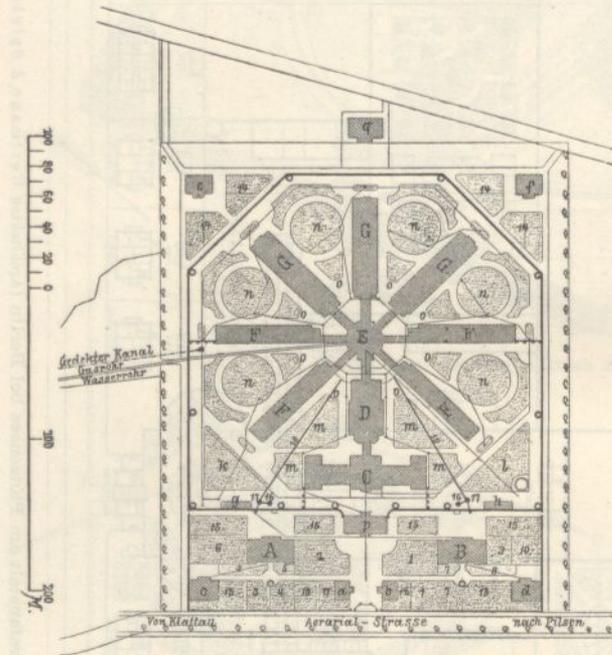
Lageplan der Strafanstalt in Pilsen
